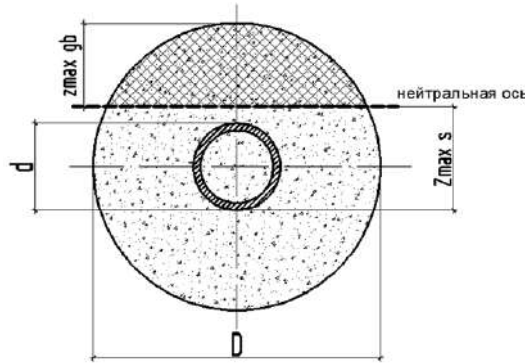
Конструктивная схема элемента вертикального грунтобетонного массива
